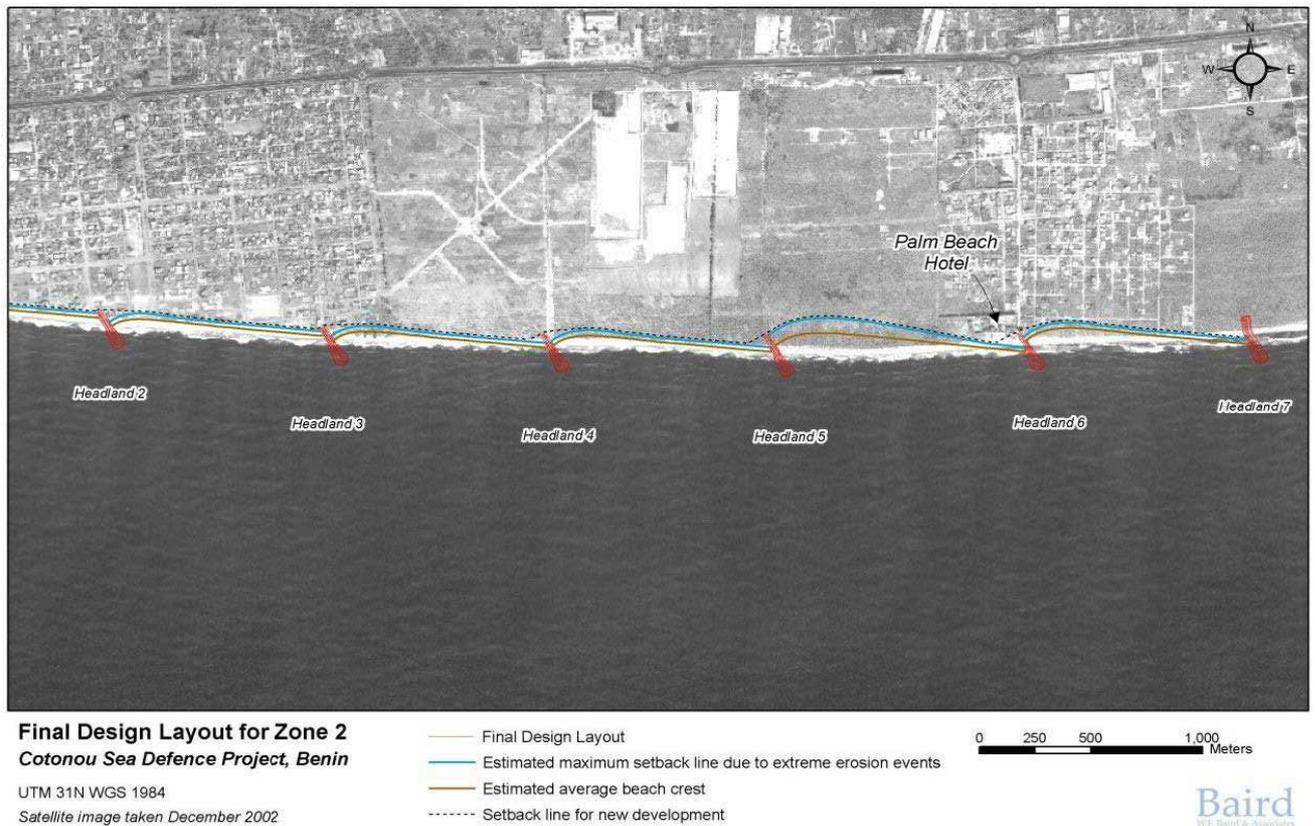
Vue d'ensemble du projet : zone 2 [19]
